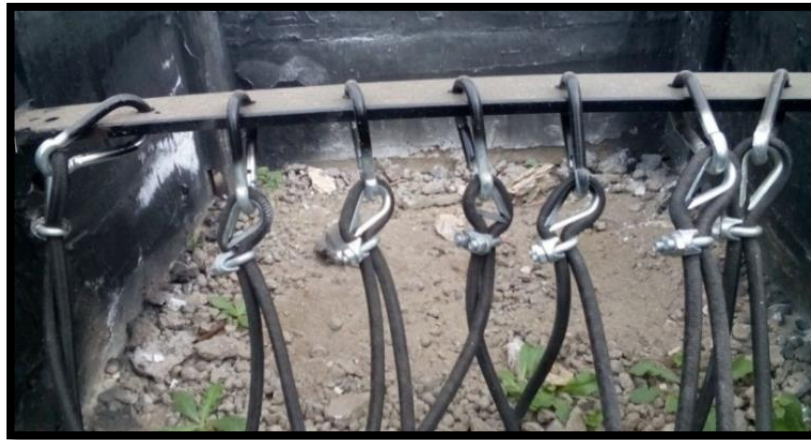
Sujeción de las bandas en la placa entre las columnas
